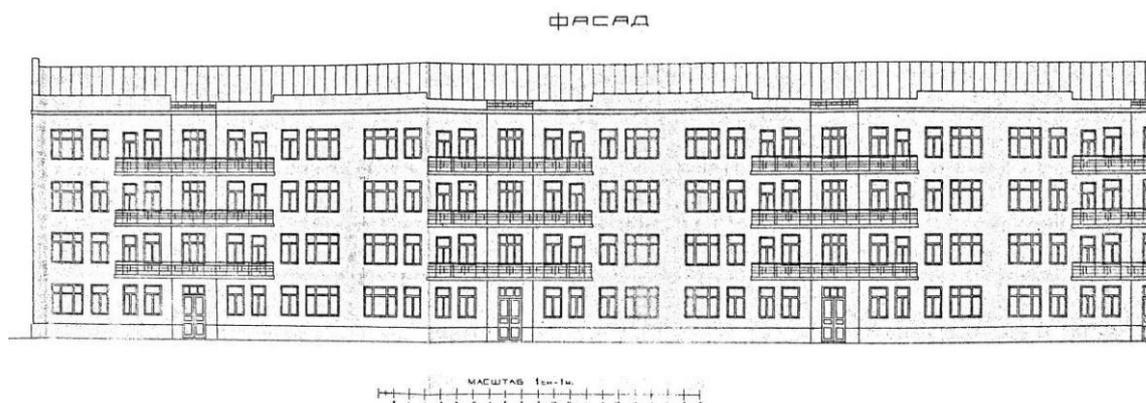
К проекту квартального строительства г.Красноярска. Фасад. Гражданский инженер С. Г. Дриженко. 1929 г. (ГАНО)
